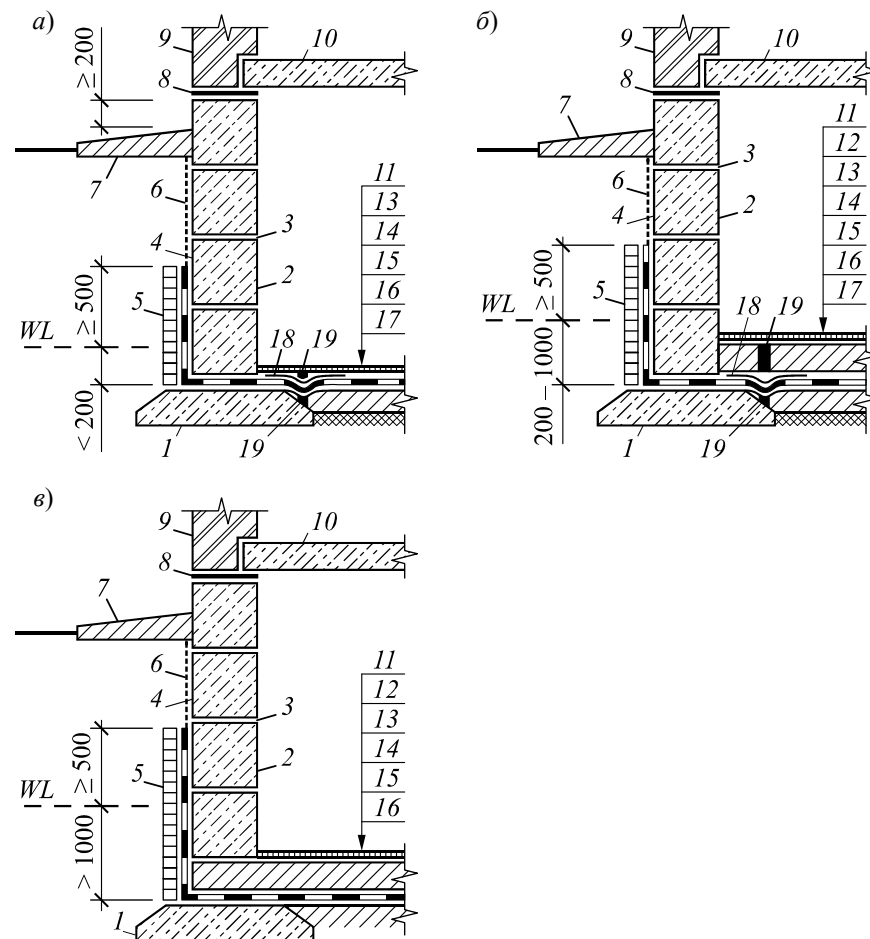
Ленточные фундаменты под стены для зданий с подвалами при различном уровне подземных вод:
